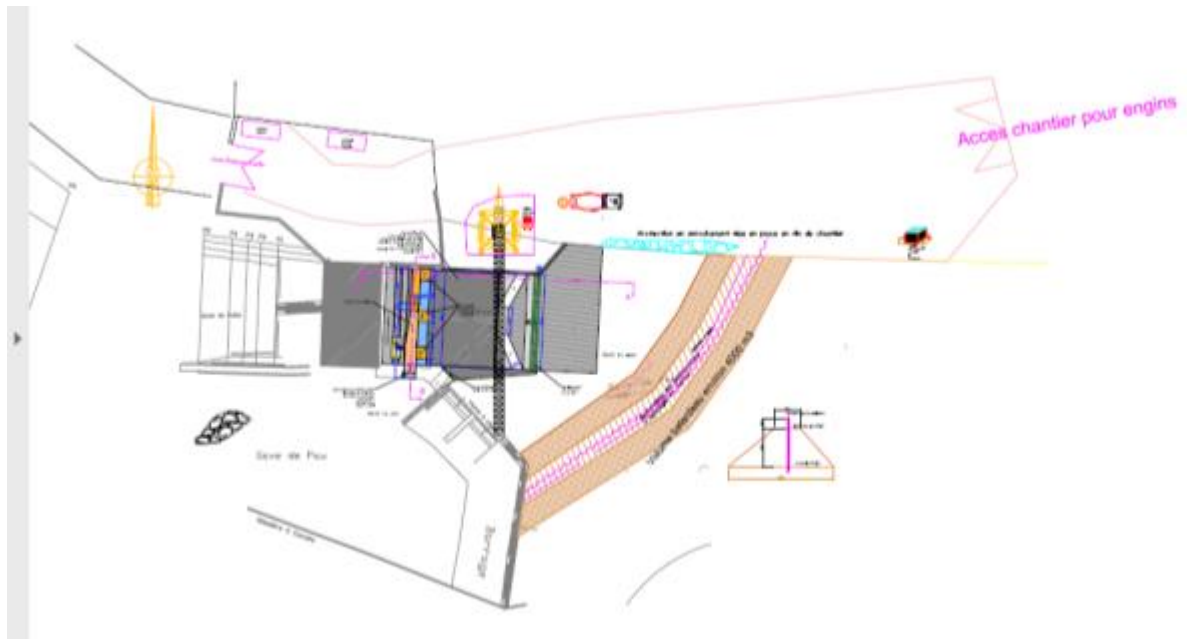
Plan de masse de la mise hors d'eau de la rive droite
